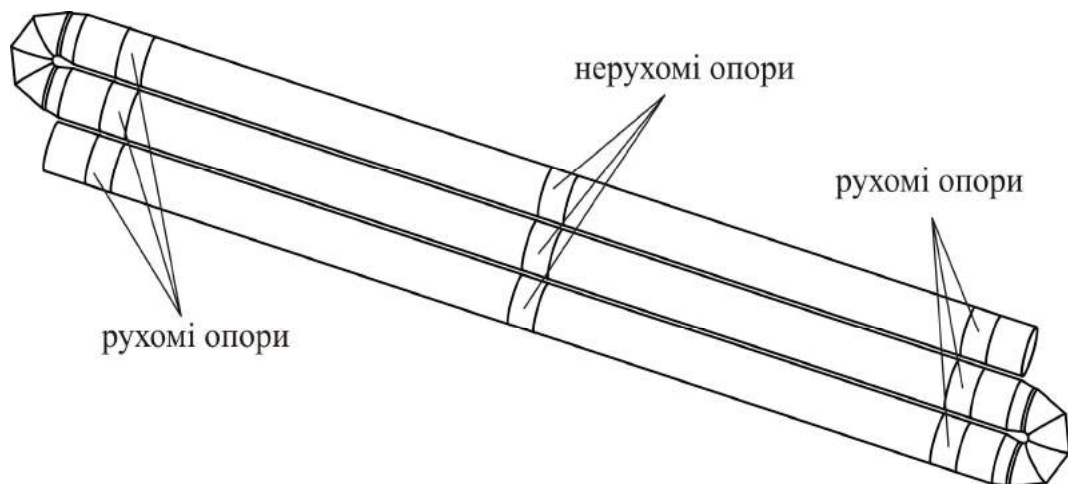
Загальний вигляд частини рухомого трубопроводу з місцями розташування опор для кріплення трубопроводу
